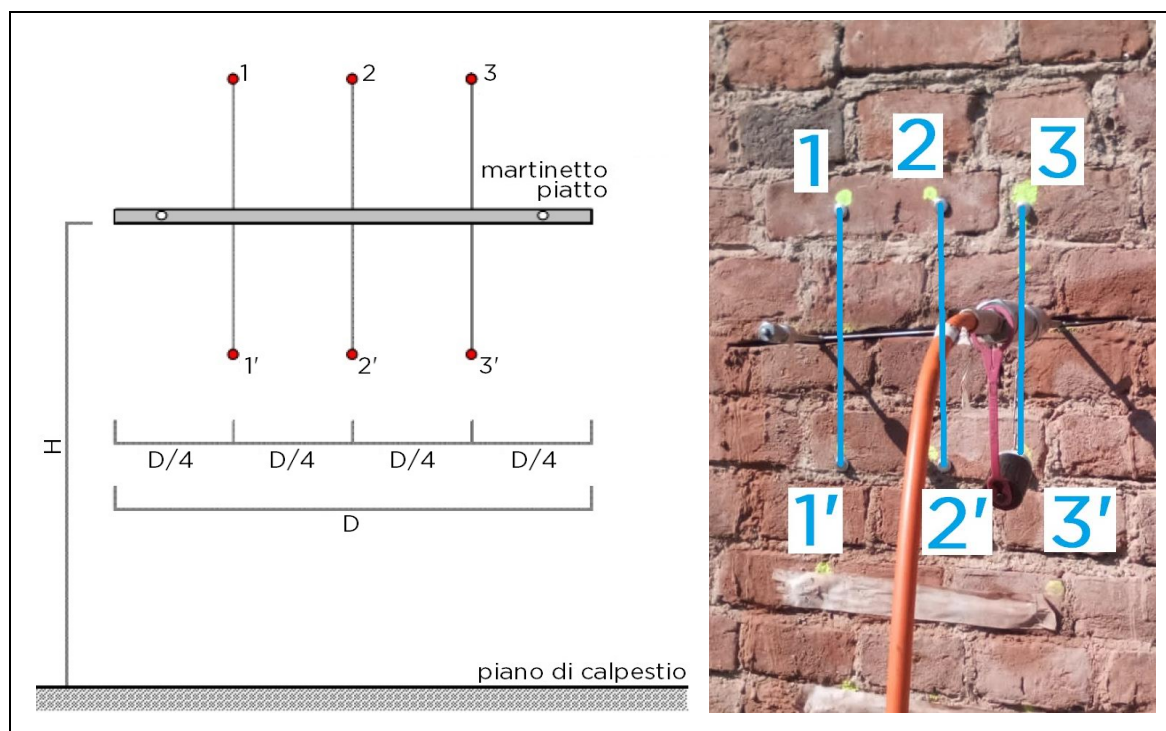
Disposizione dei capisaldi per la prova del martinetto piatto singolo
